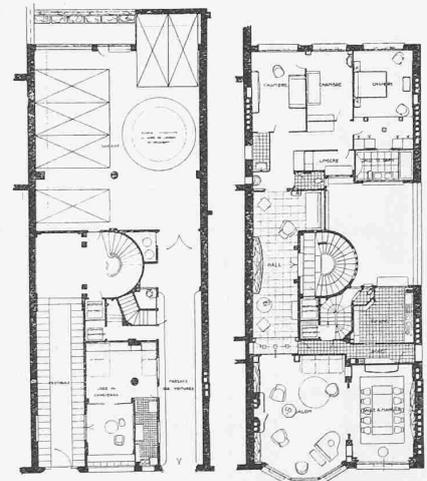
und 2. Grundrisse 1 : 400.
